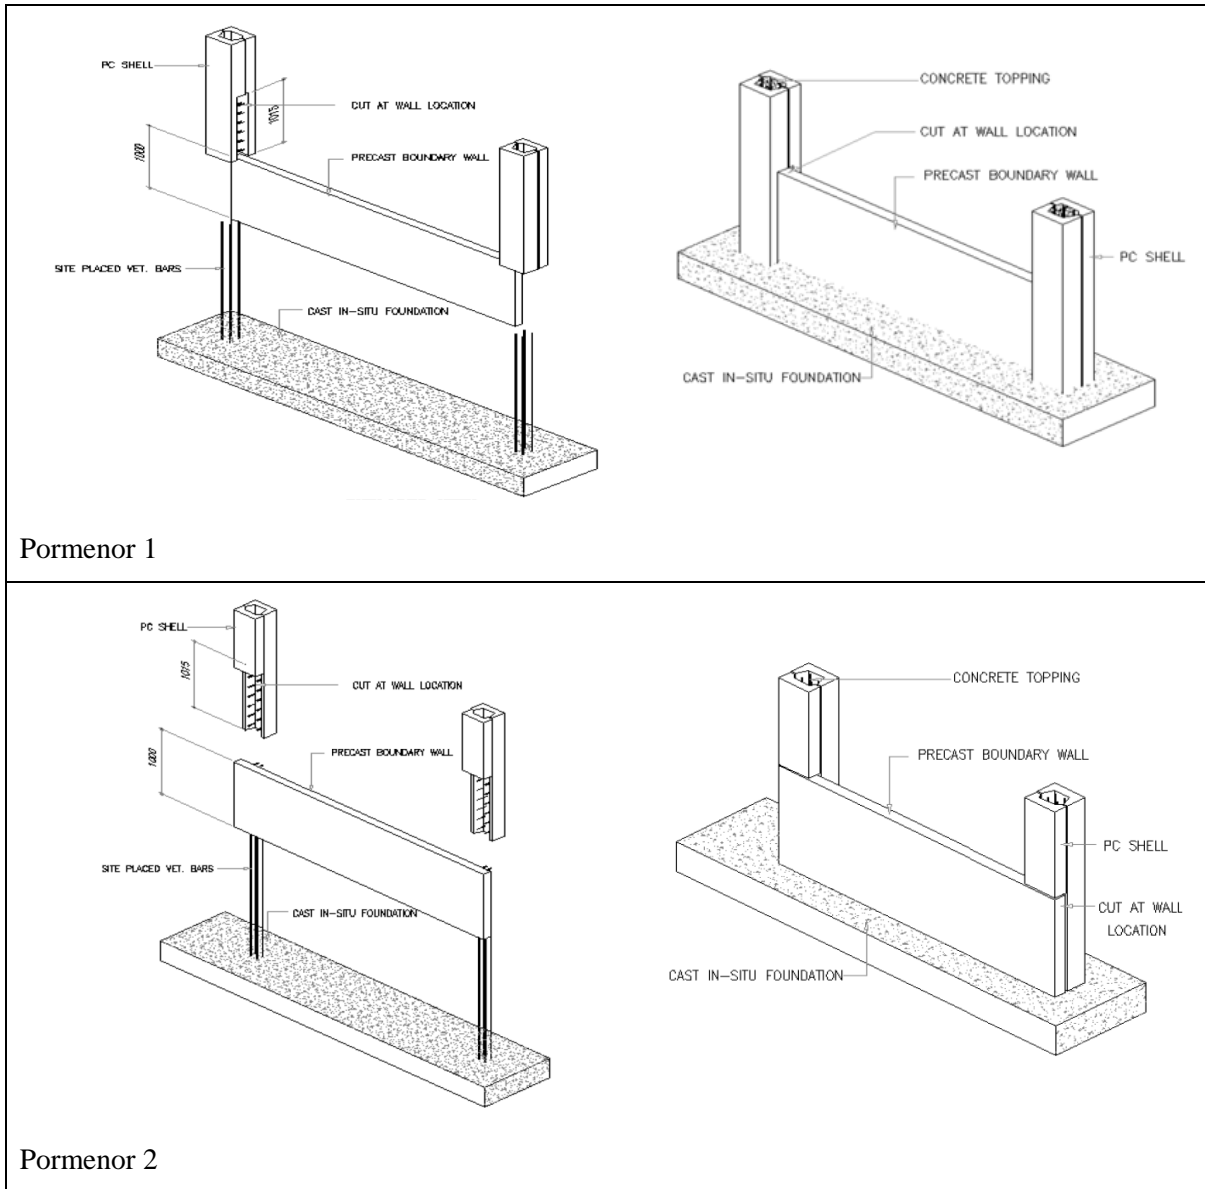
Pormenores de ligação de muros de vedação, pilares e fundação
